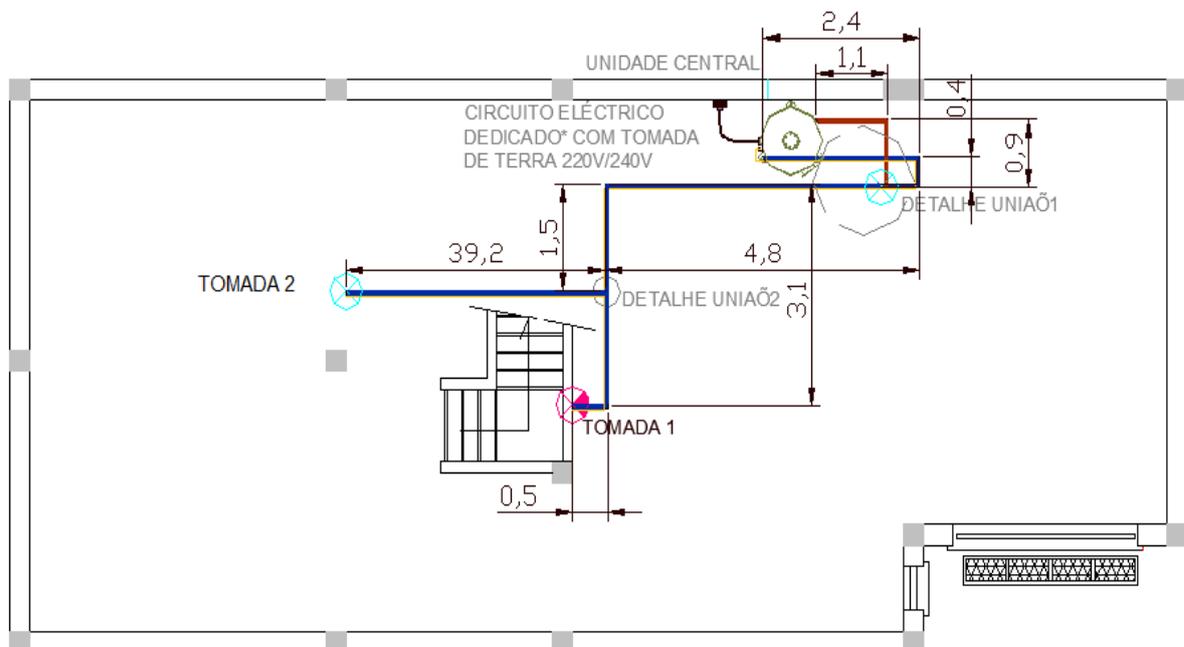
Cave – Solução A - Traçado e Dimensionamento em planta
